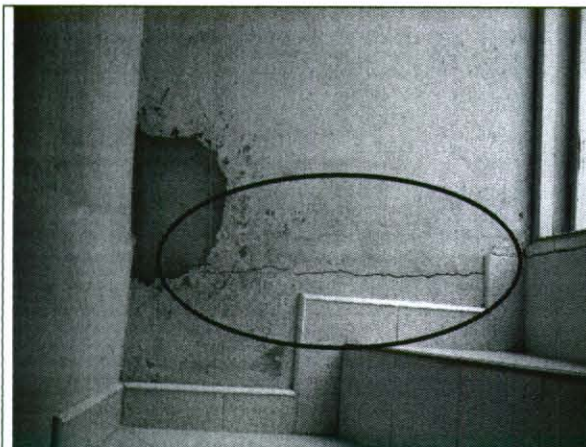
Estado de fisuración moderado en muros interiores en zona de la escalera.
